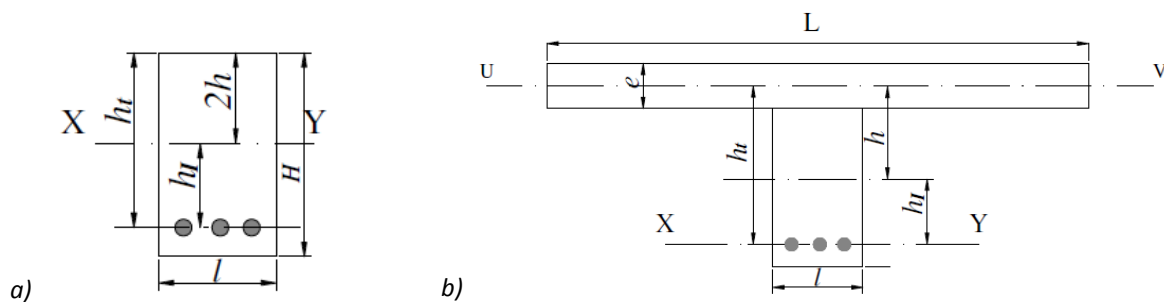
Sezione di riferimento (a) rettangolare e (b) a T
